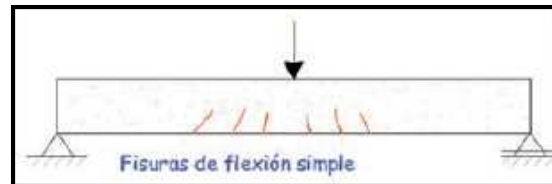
Esquema-Fisuras en vigas por efectos de Flexión Simple. Imagen en Ref. [5]
